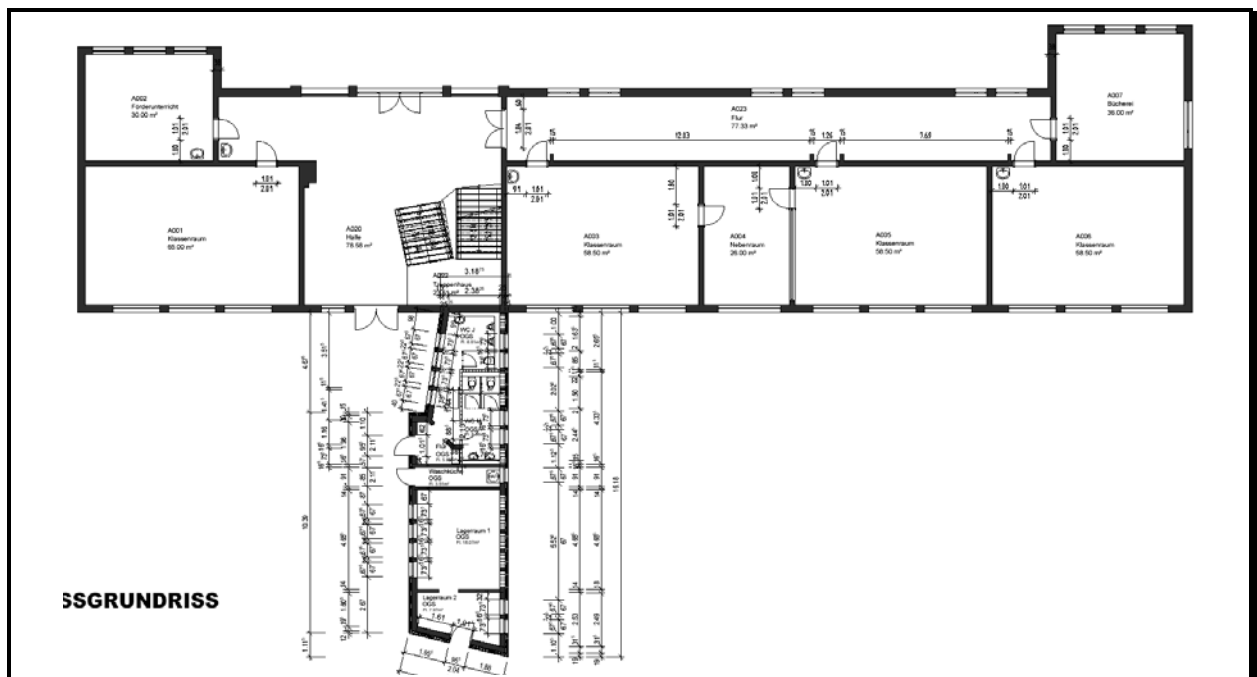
Deutscherrenschule: Grundriss Bauteil A Erdgeschoss
